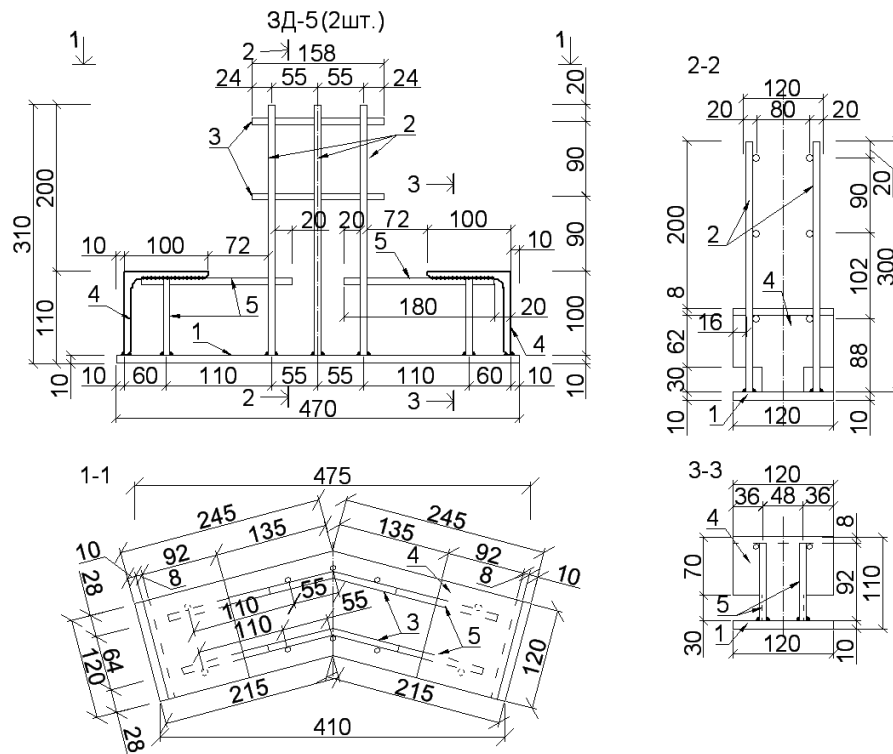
Арматурний каркас К-5 для криволінійної надопорної монолітної головної балки: 1- лист із Ст-3, 2 – поперечні арматурні стержні Ø8 мм А400С, 3 – конструктивна арматура Ø8 мм А400С, 4 – кутник 100х100х8 мм із вирізами, 5 – анкерні стержні Ø8 мм А400С.
